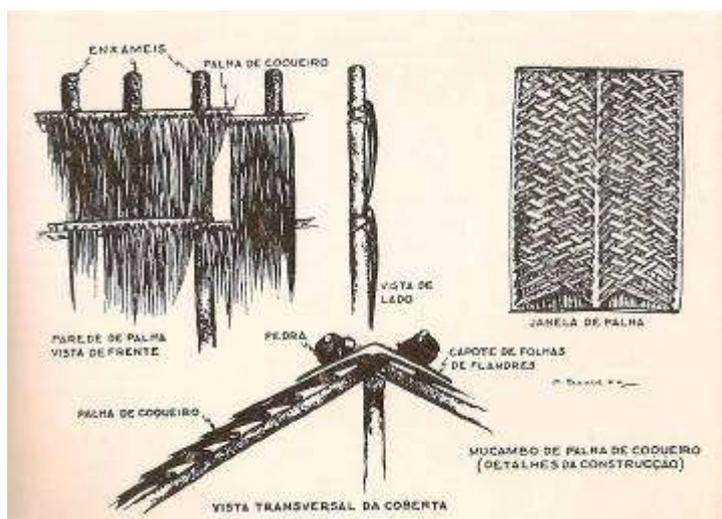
Desenho de M. Bandeira. Mucambo do Nordeste, detalhe das construções em palha
